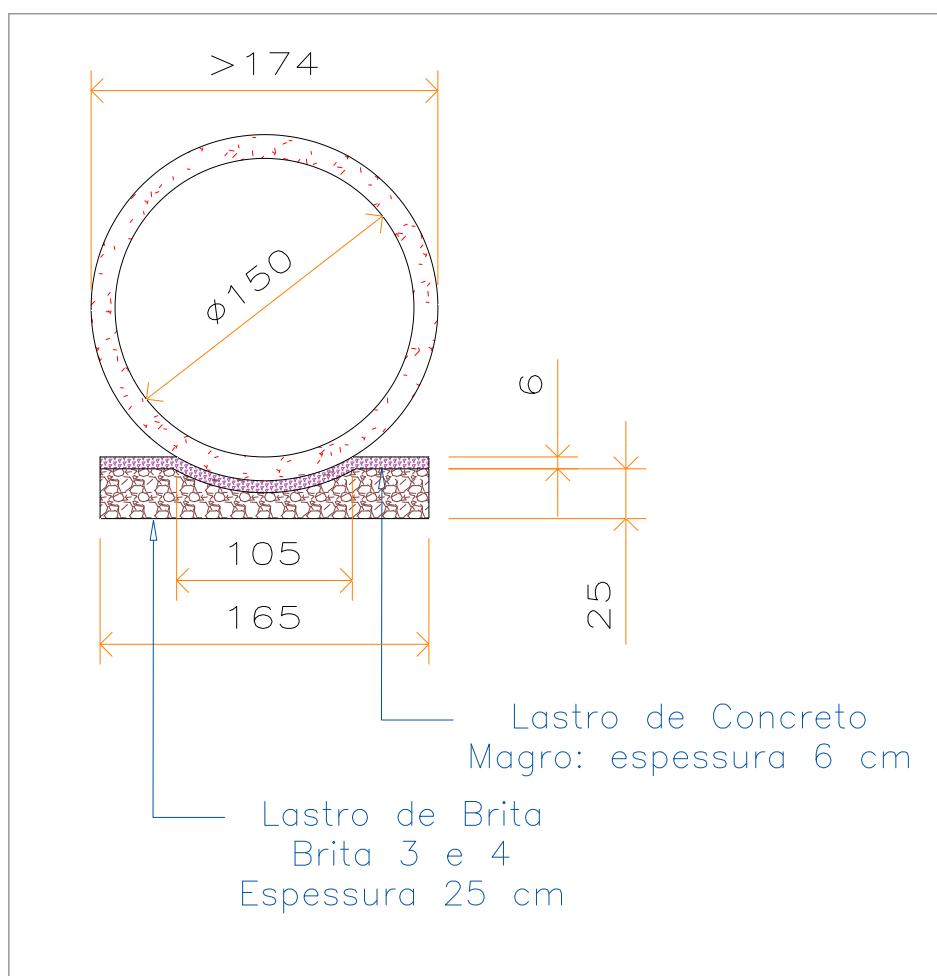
Base de apoio para assentamento dos tubos de concreto, com diâmetro de 1,50 metros
